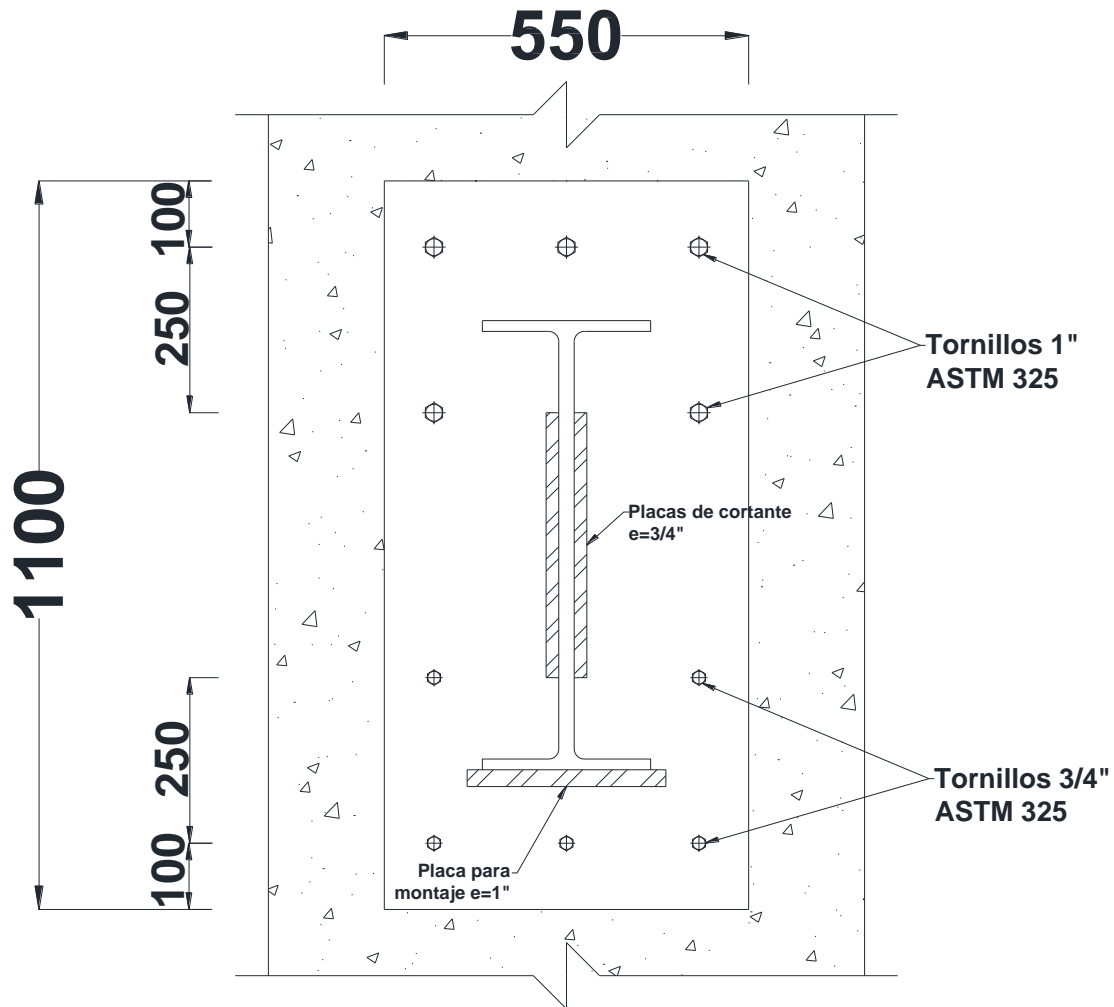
Sistema de conexión entre elementos de concreto y acero, dimensiones en mm.
